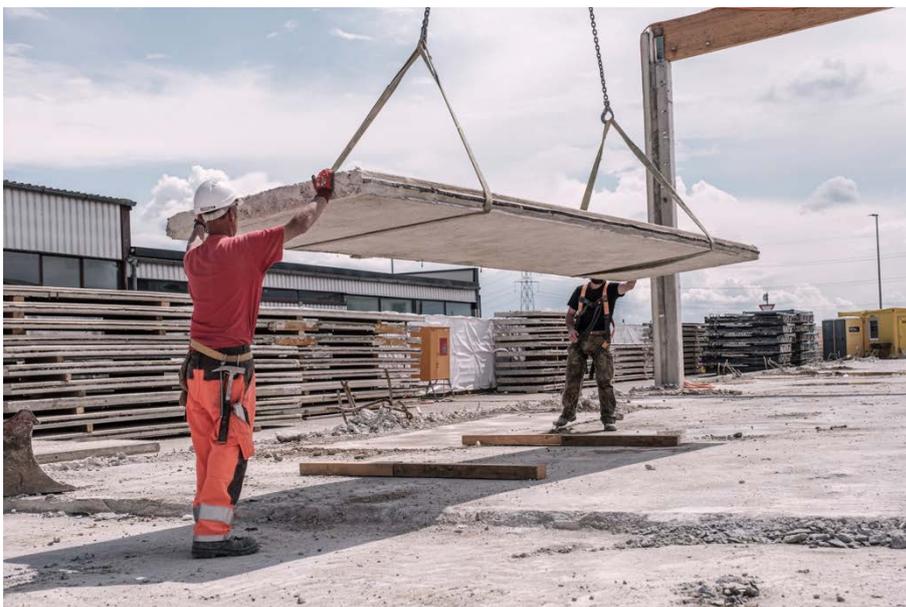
Stockage des panneaux béton au Centre de formation FVE Echallens (photo ZAK)
